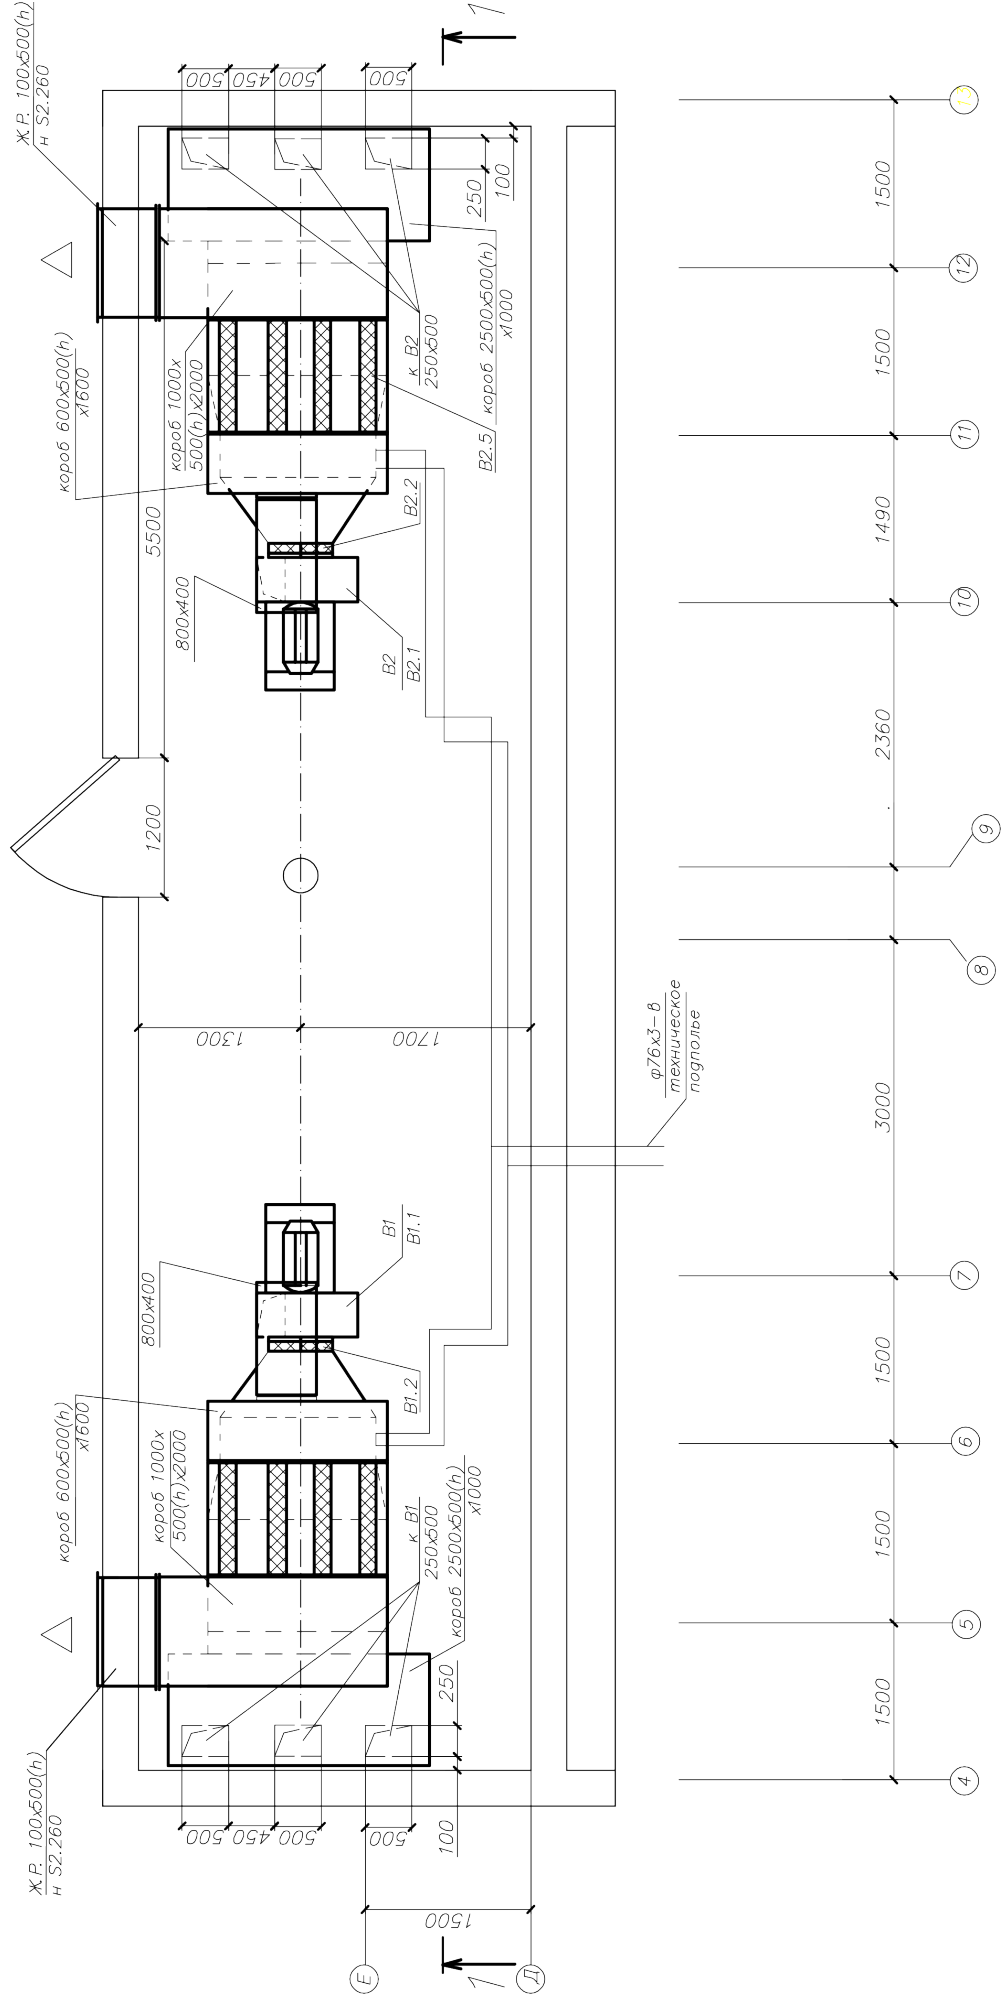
План помещения с оборудованием для утилизации тепла вентвыбросов
